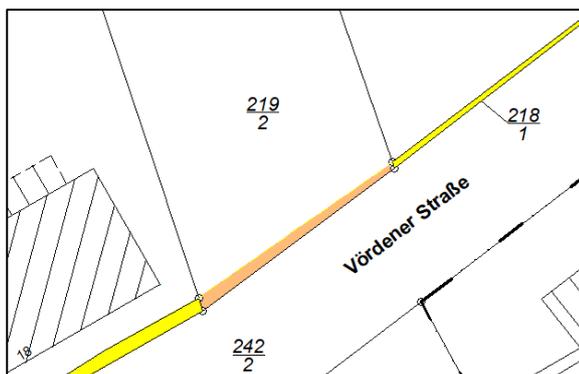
Lageplan Erweiterung der Vördener Straße (ohne Maßstab)
